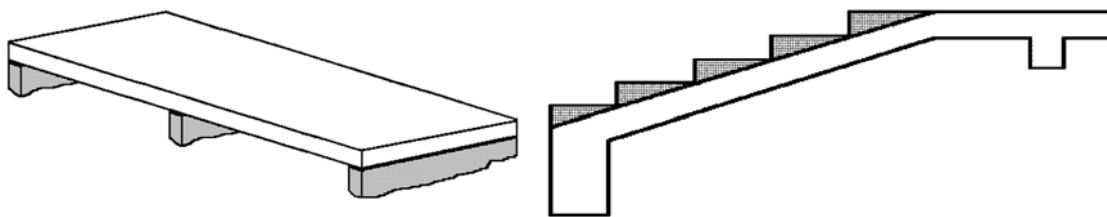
Losa unidireccional apoyada sobre muros y sobre vigas
